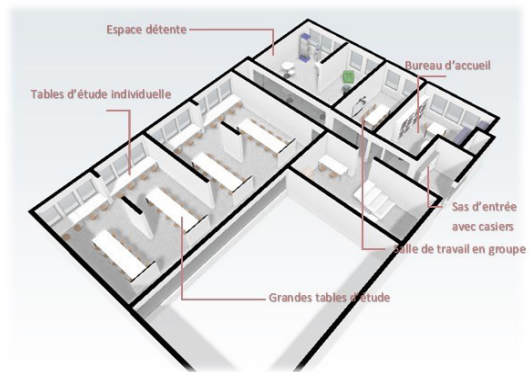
Plan de réaménagement fait sur www.floorplanner.com
